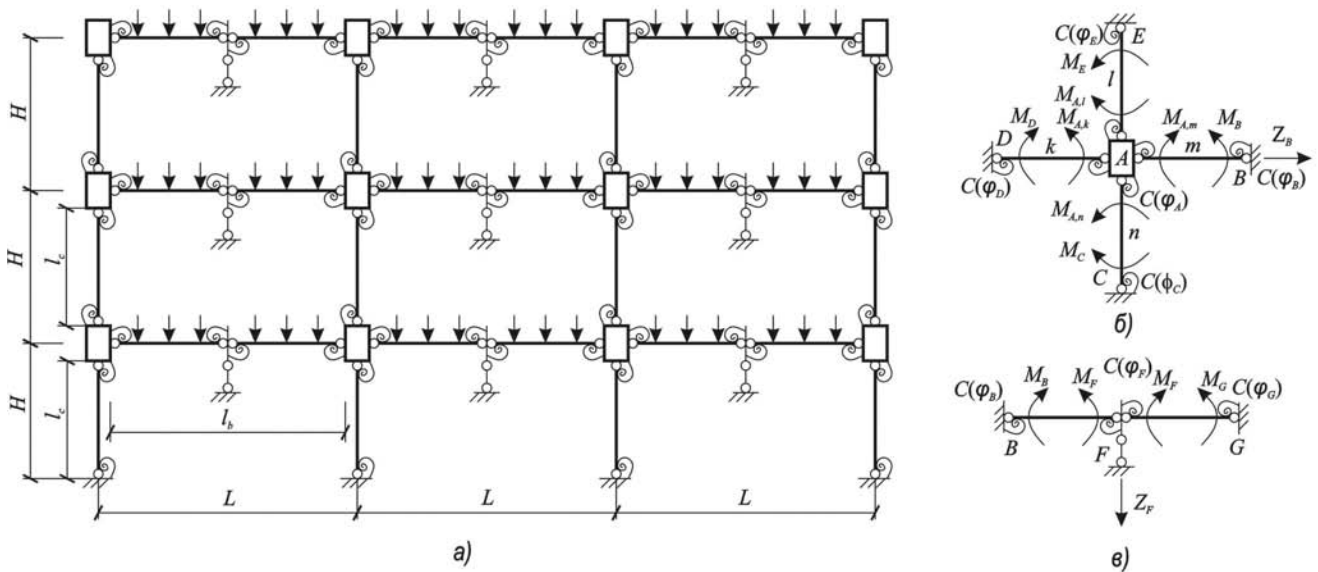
Расчётная схема неординарного смешанного метода для расчёта устойчивости железобетонных каркасов зданий при структурных перестройках, вызванных особым воздействием: а) общий вид схемы; б) схема узла сопряжения колонн и ригелей; в) схема для произвольного нормального сечения по длине ригеля
